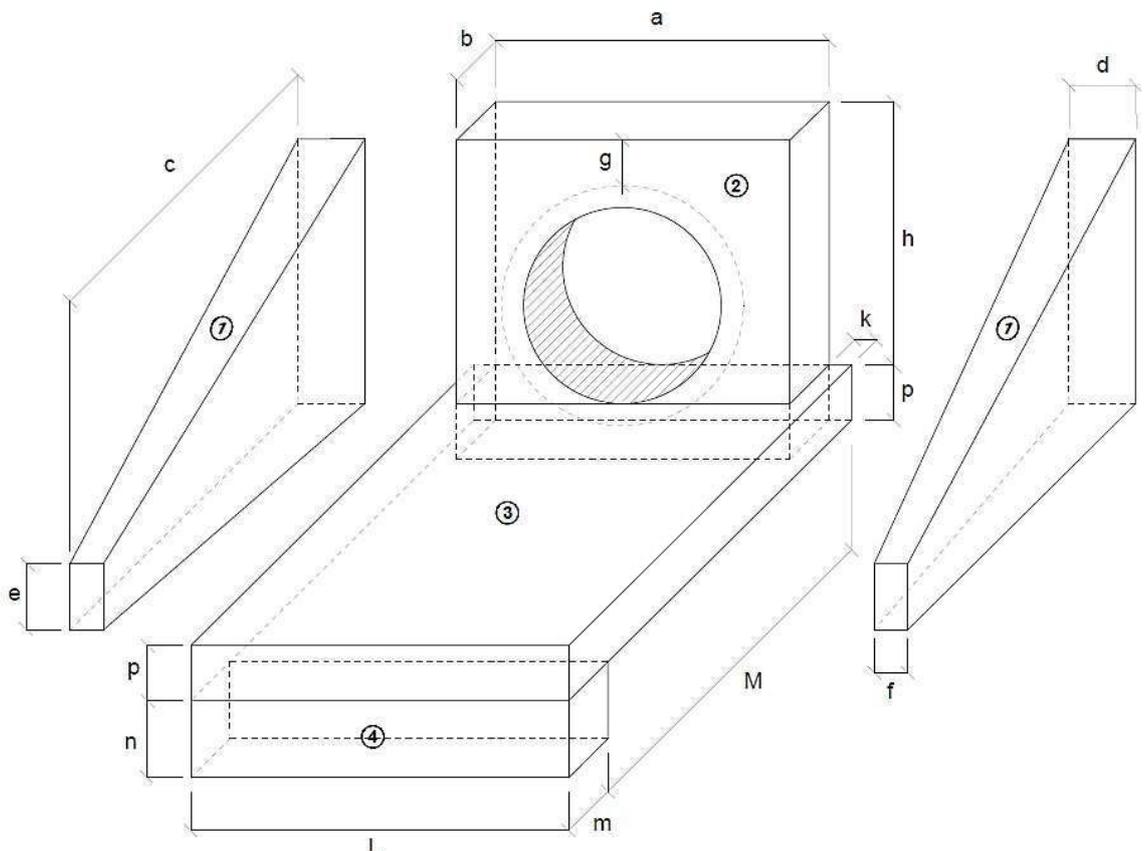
Detalhamento das dimensões da boca de bueiro simples com alas retas
